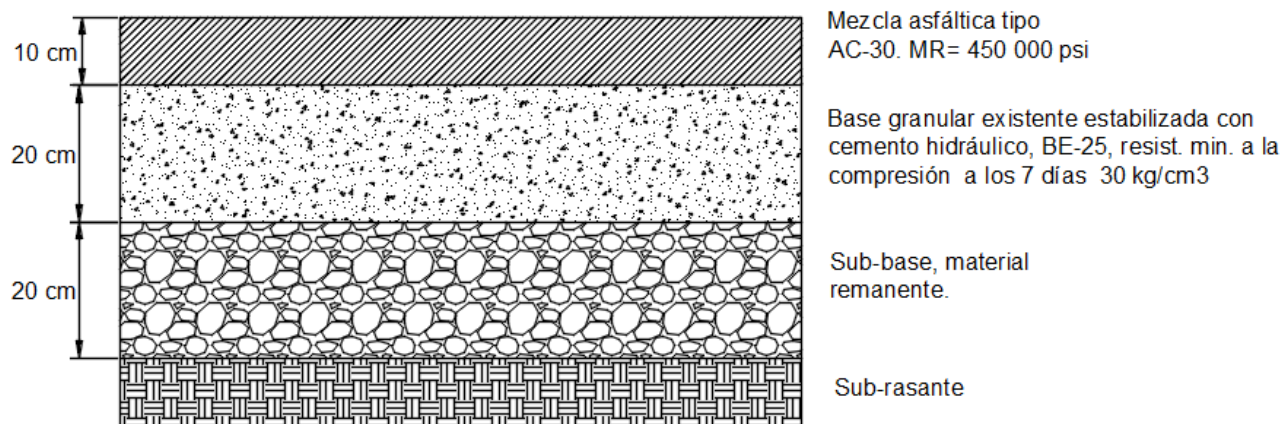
Perfil de la estructura de pavimento propuesta para el TH=35.
